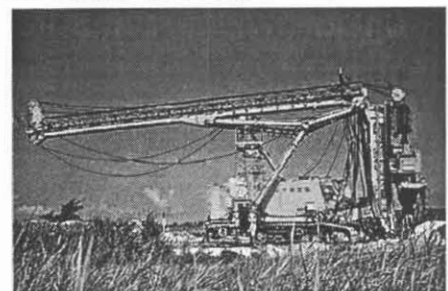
リーダー傾斜式 SCP 施工機⁴⁾
